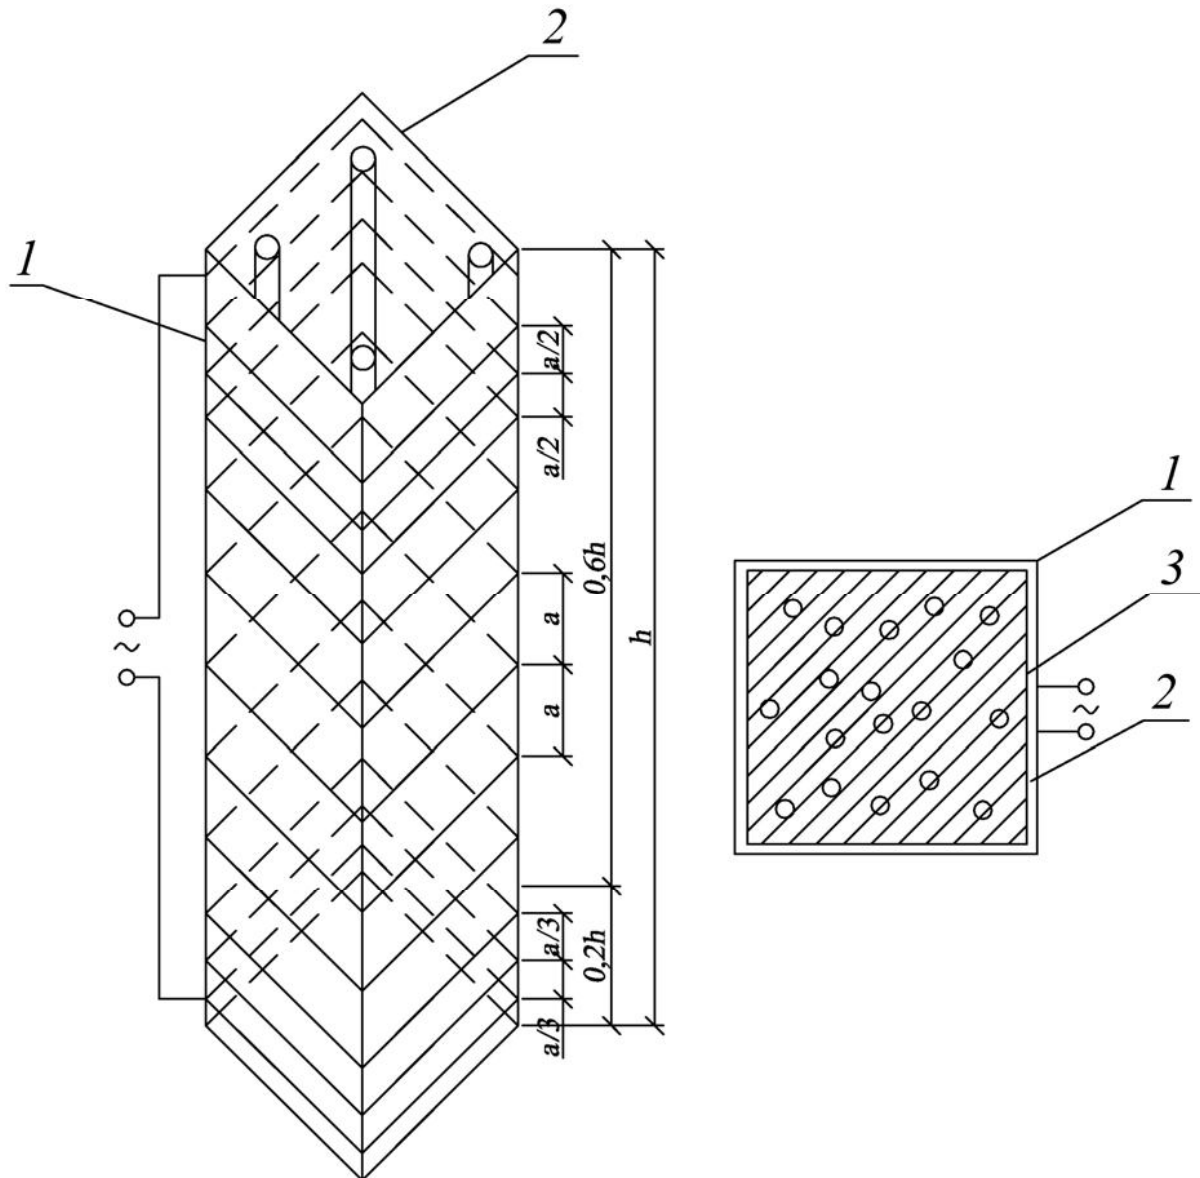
Схема індукційного прогрівання: a – крок між витками; h – висота індуктора; 1 – індуктор; 2 – стрижнева арматура; 3 – металева опалубка
